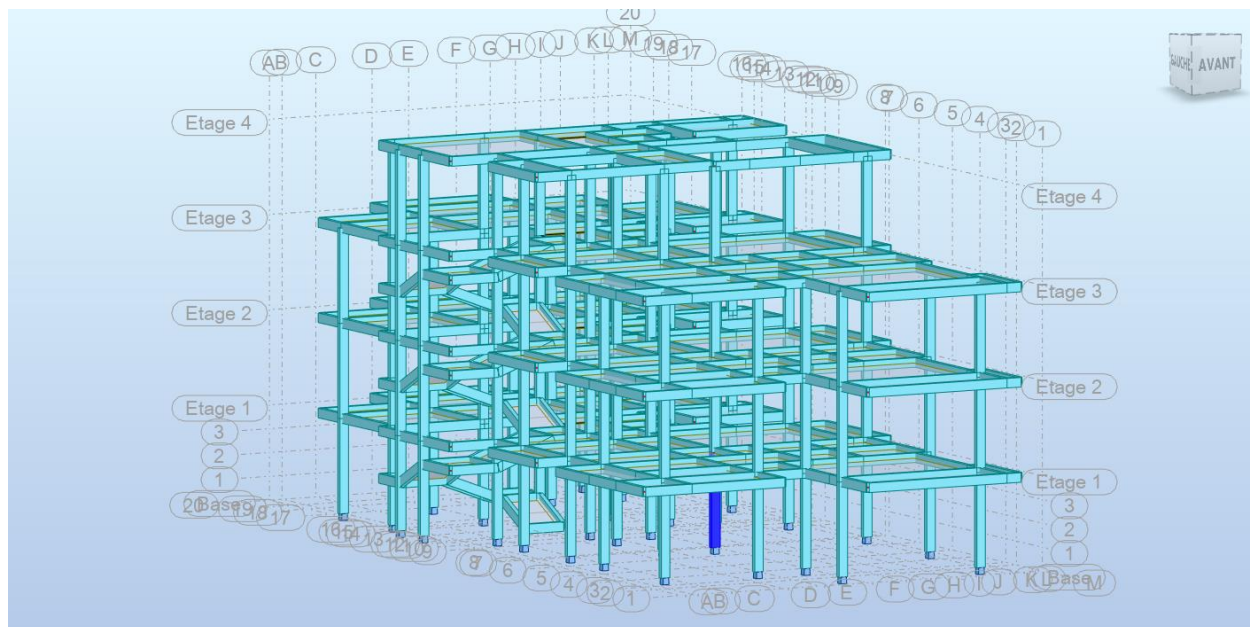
Emplacement du poteau 122 (le poteau le plus chargée)
